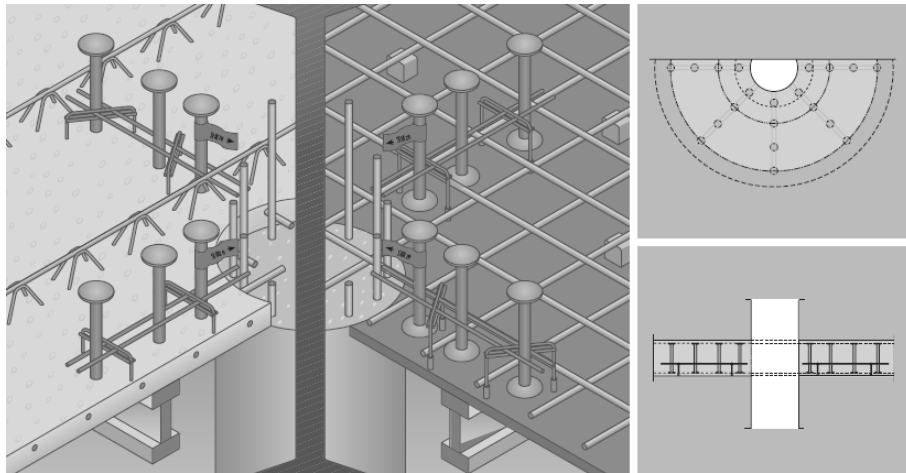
Detalhes dos sistema de armaduras – SCHÖCK BOLE.
